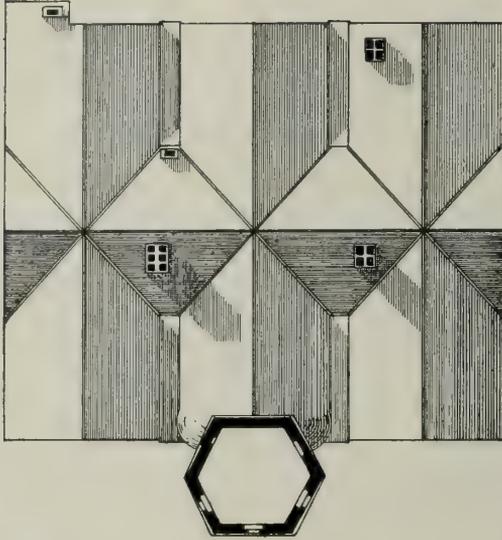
Demerthin. Schloß, Dachansicht und Erdgeschosgrundriß, nach einer Aufnahme von Altgelt.
